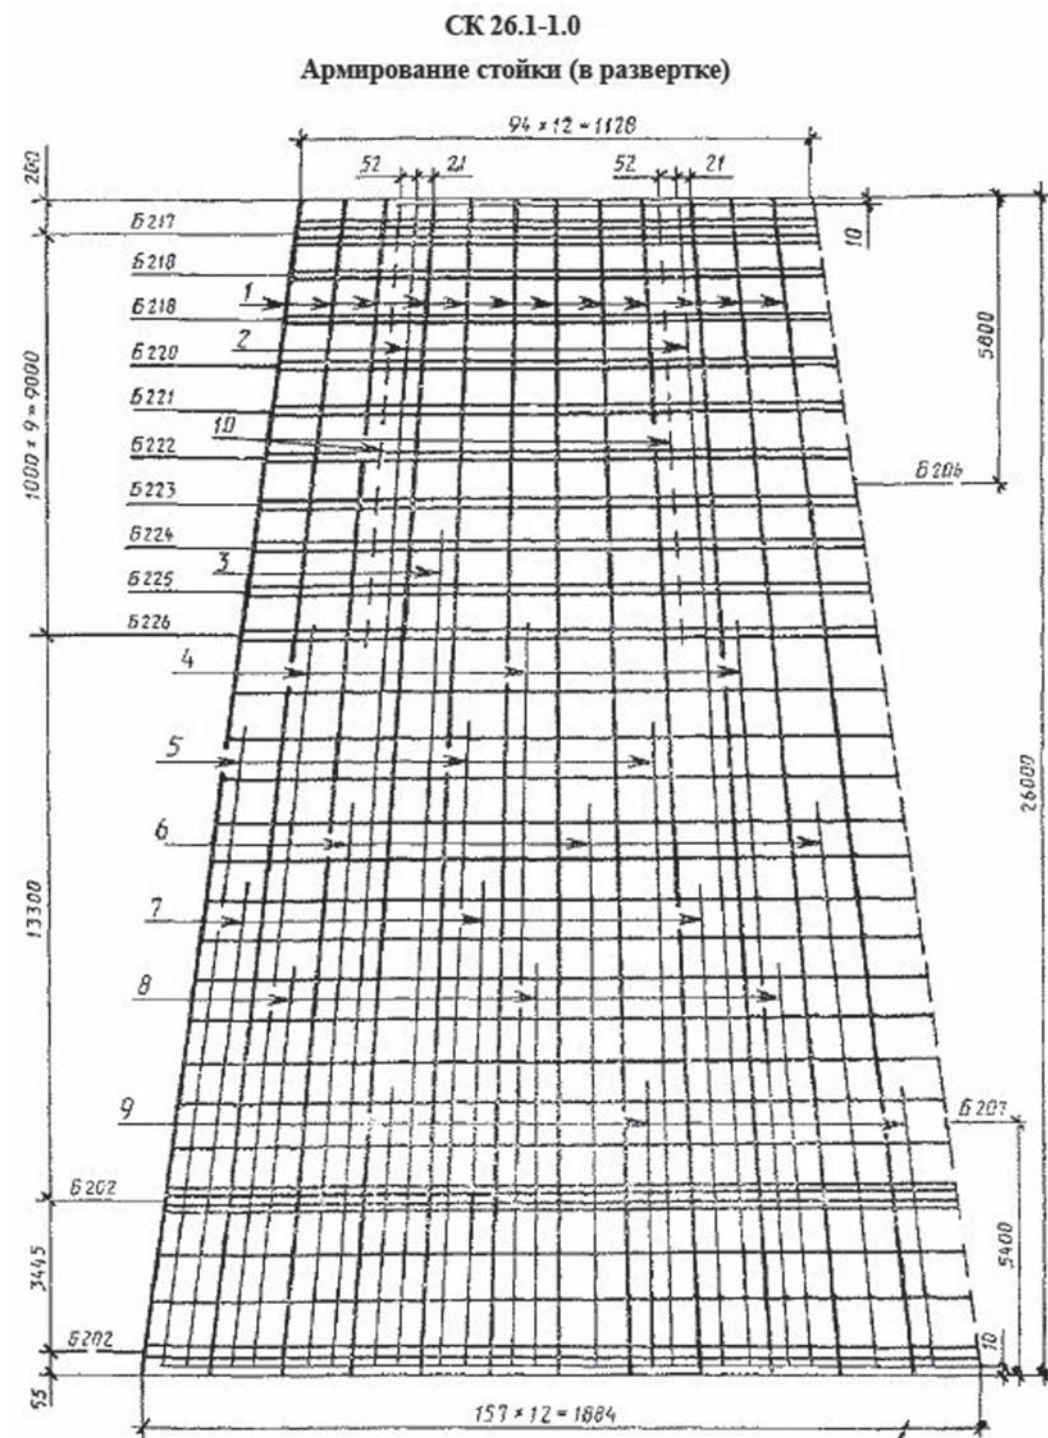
Армирование стойки СК 26.1-1.1 (в развертке)
